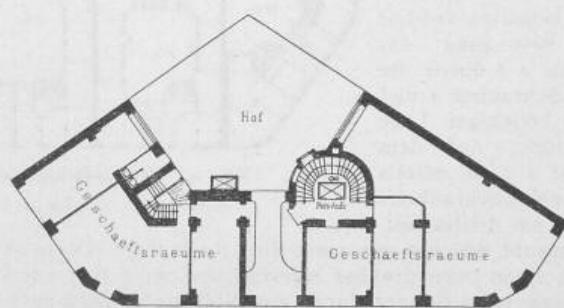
Kaufhaus Köln. Erdgeschoss 1:500.
